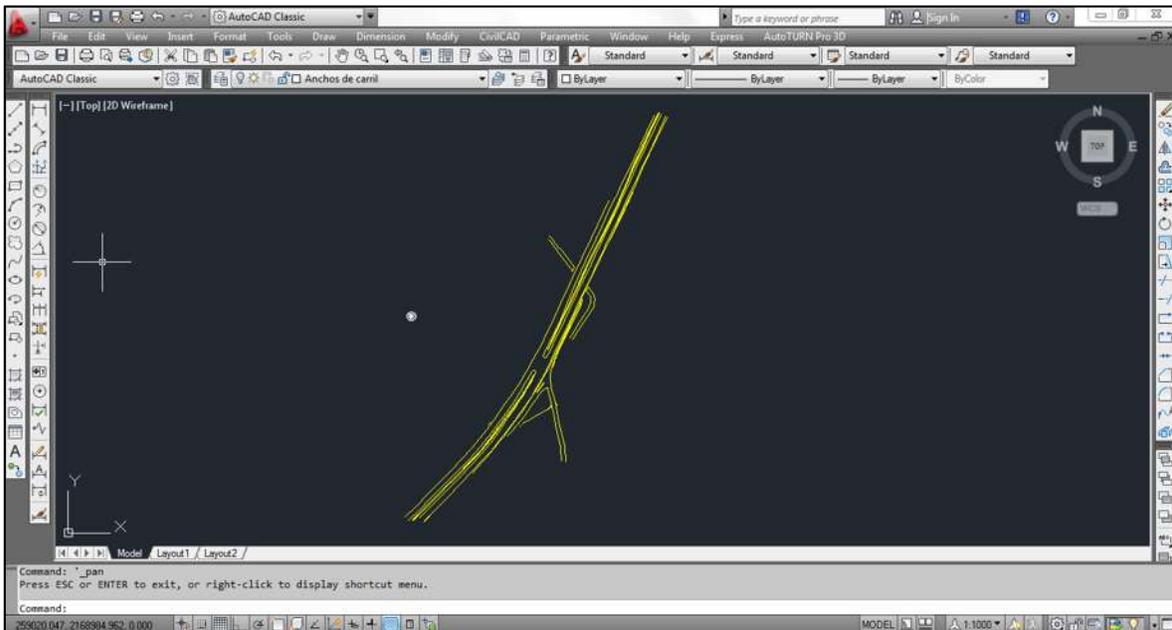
Dibujo de la planimetría levantada en campo. Fuente: propia.
